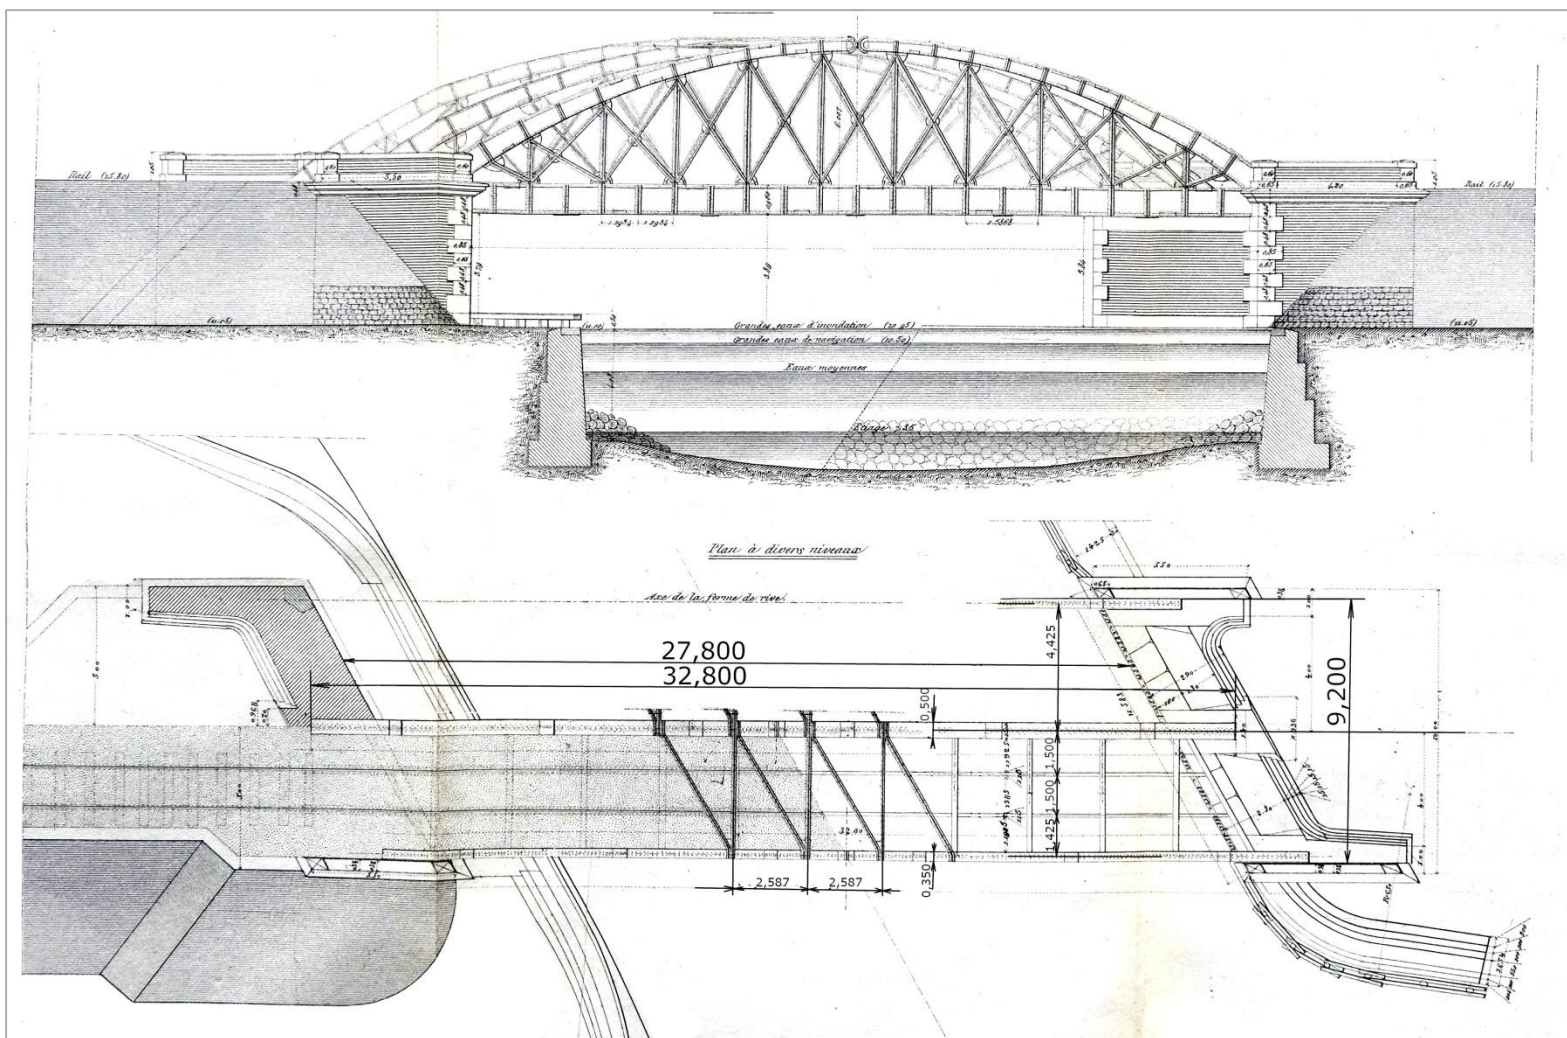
Vues en élévation et en plan du pont sur l'Escaut (extrait de Dallot⁶)
